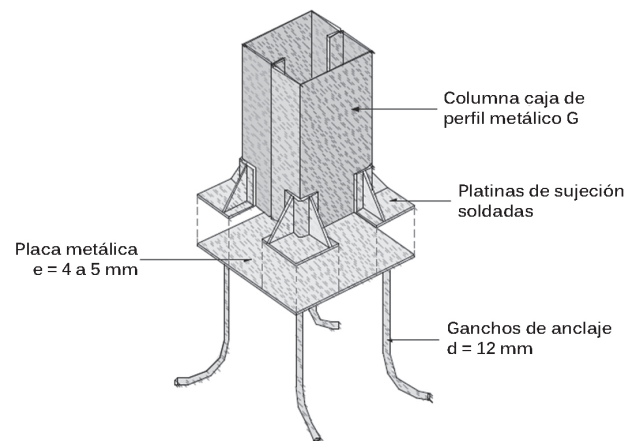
Detalle del empotramiento de una columna metálica y la base de la cimentación mediante platinas soldadas
